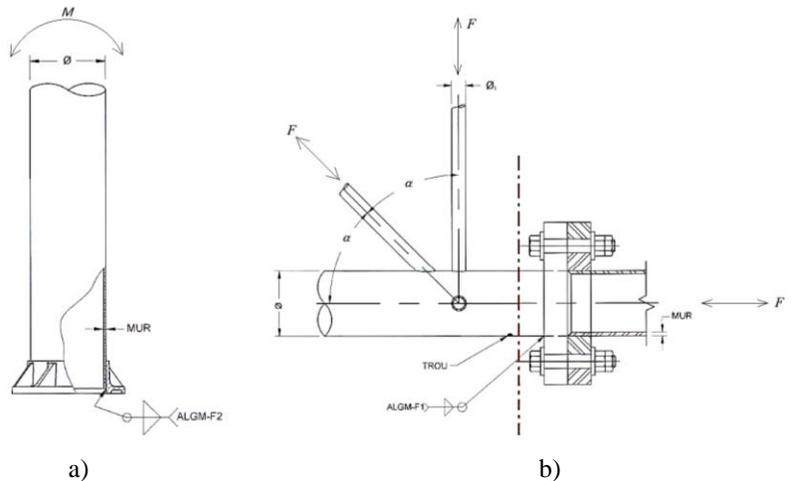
Essais expérimentaux - a) assemblage à la base d'un poteau rond - b) assemblage en K
